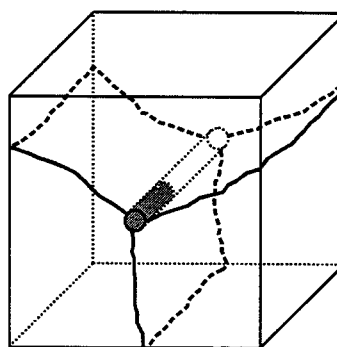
Rißbild eines Versuchskörpers aus Beton M 105 KS mit geripptem Spanndraht
